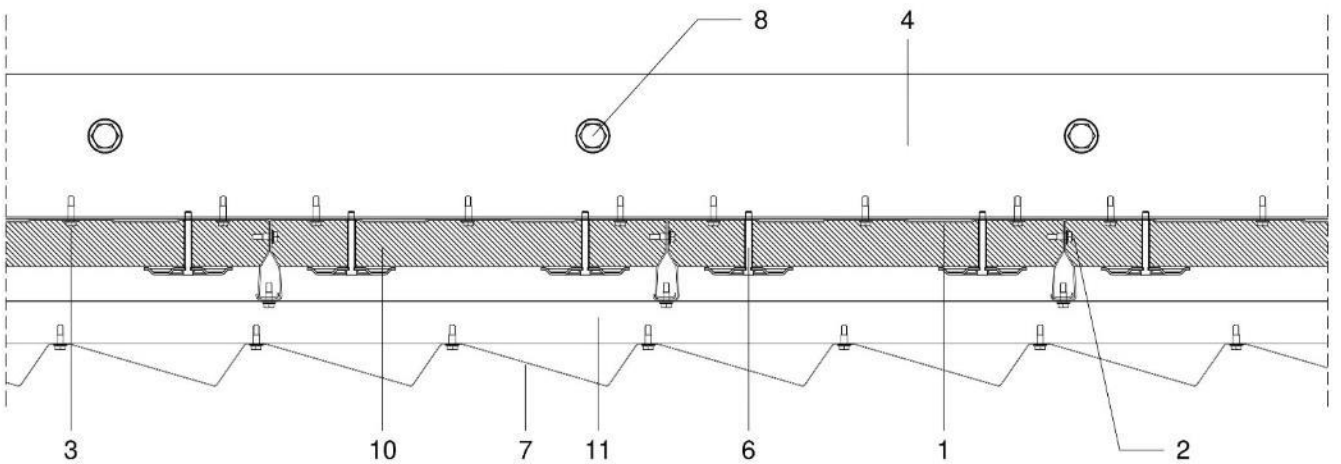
e: Sección horizontal con aislamiento y revestimiento de chapa Atenea en vertical.
